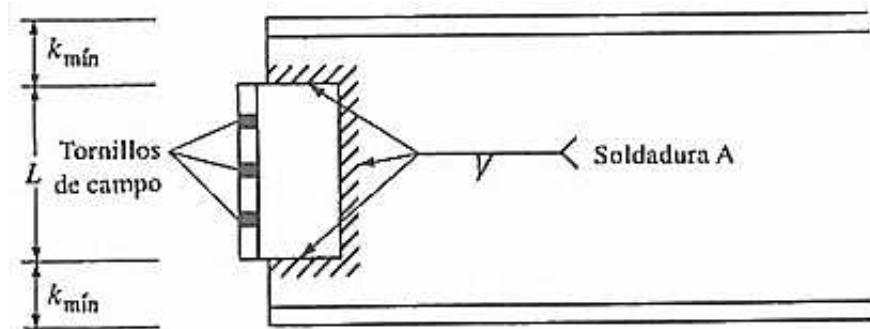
8: Soldadura de conexión entre ángulo y viga.
